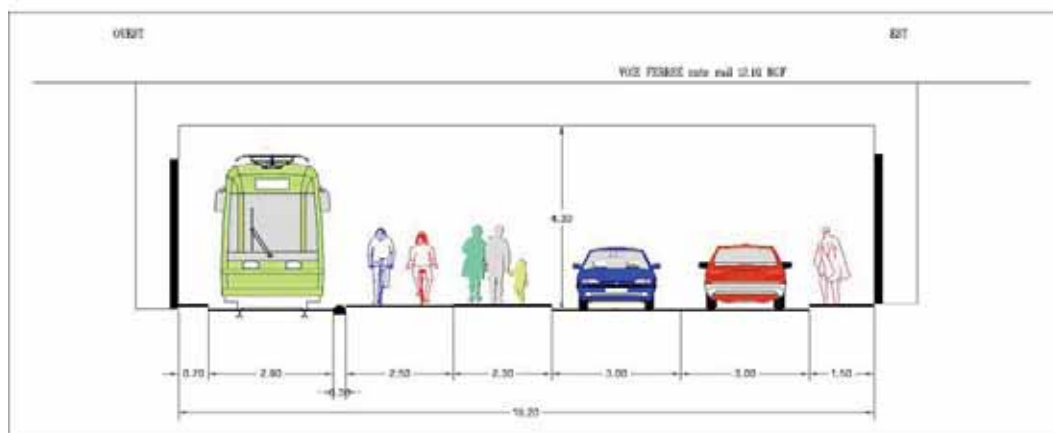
Profil en travers avec tramway– ouvrage inférieur de la bifurcation de Beyreman
